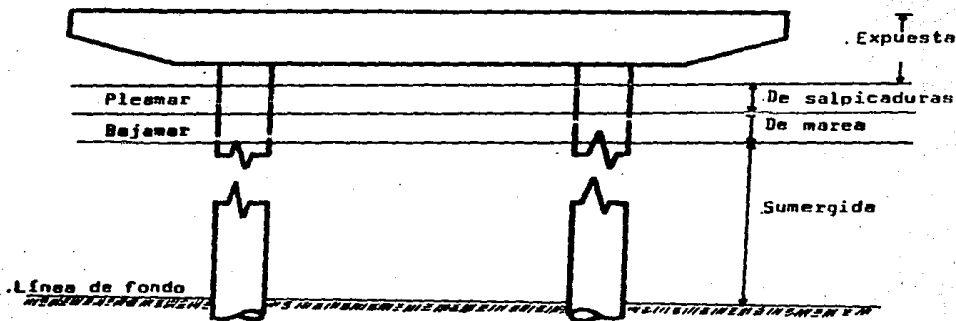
PARTE INFERIOR DE LA SUPERESTRUCTURA
